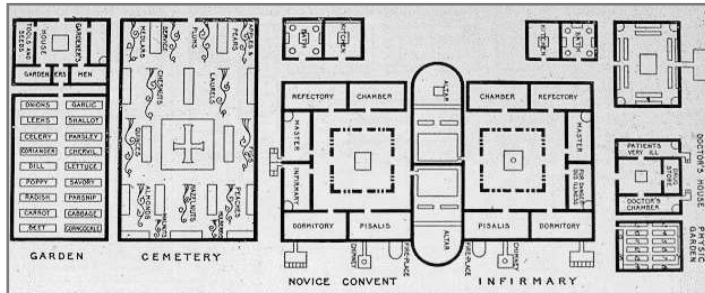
Detalhe da planta do mosteiro conservada em St. Gall – Área do Jardim. Fonte:
